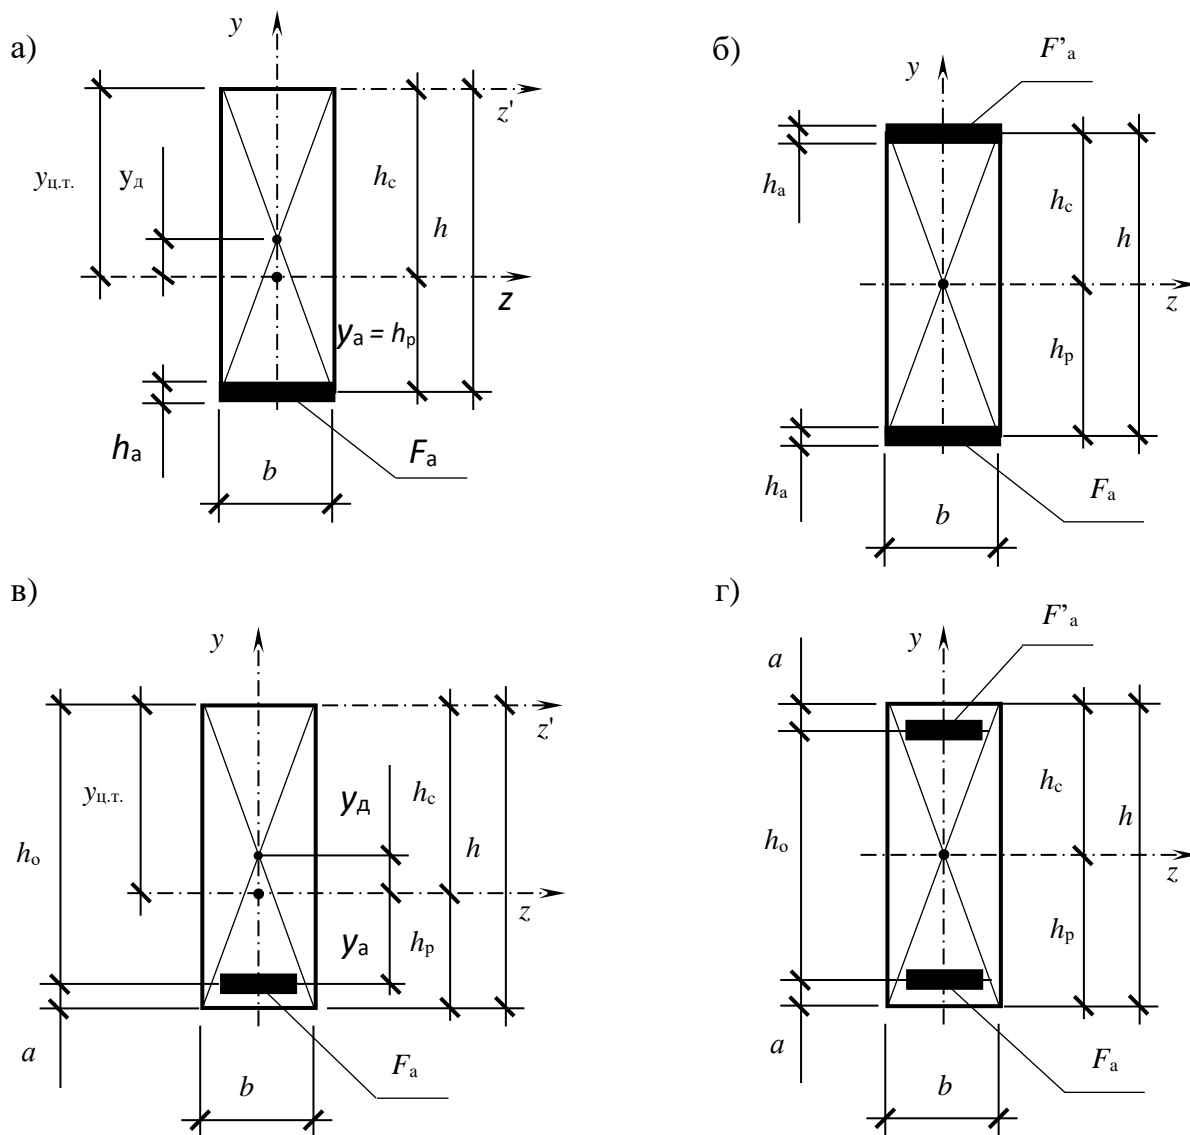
Поперечные сечения армированных деревянных балок:
